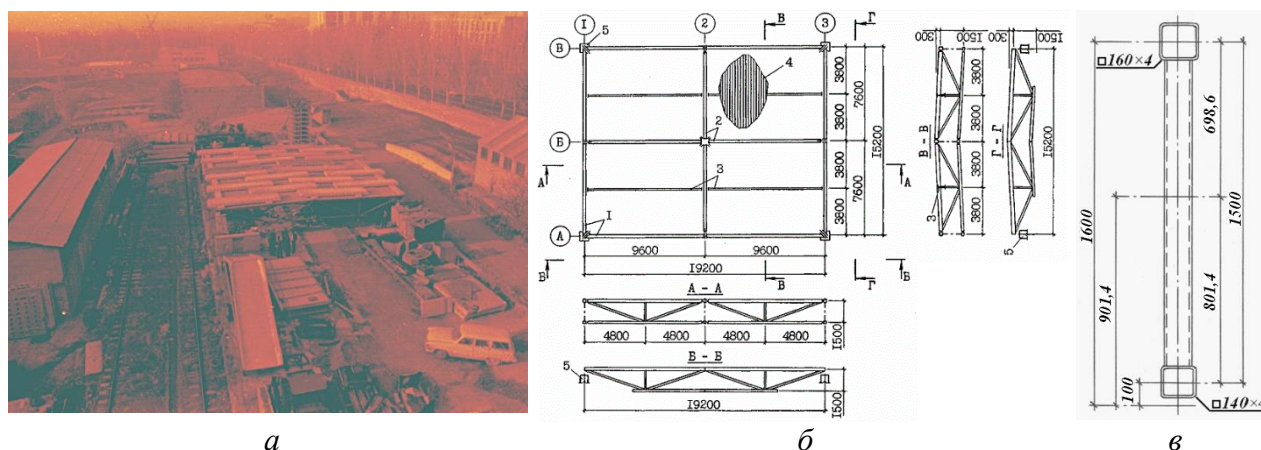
Снимок испытательного полигона (а), схемы блока покрытия (б) и поперечного сечения его контурных и внутренних ферм (в): 1 – контурные фермы; 2 – внутренние фермы; 3 – прогоны; 4 – профилированный настил; 5 – угловые опоры
